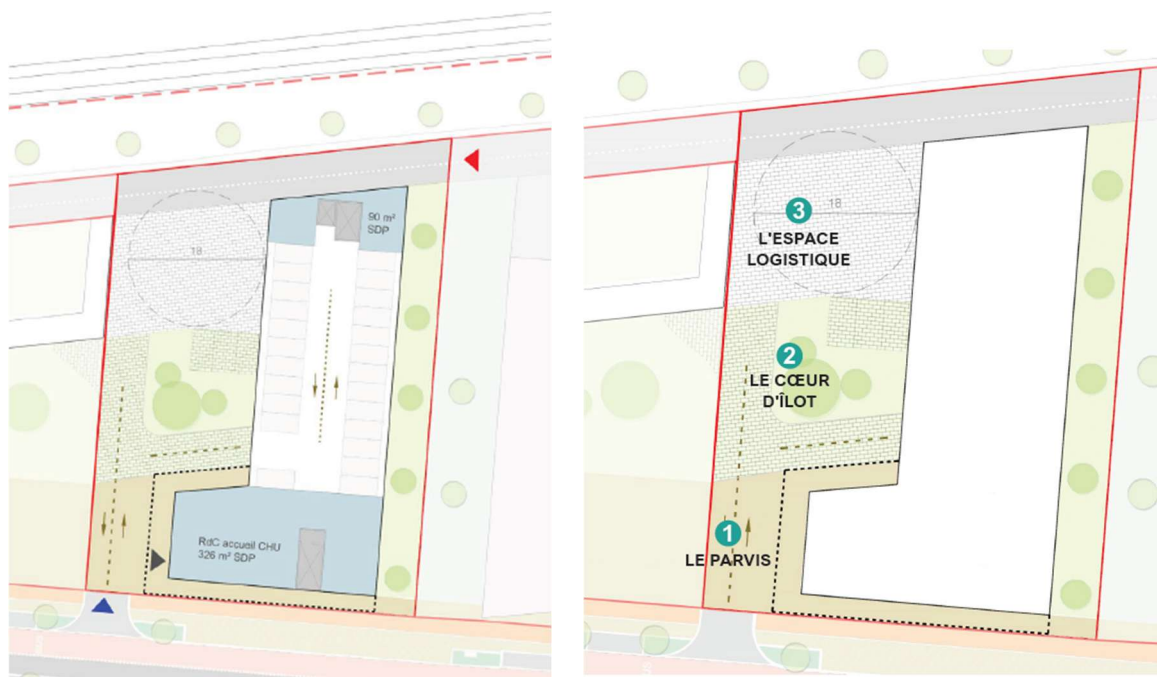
Plan du RDC et des espaces extérieurs (extrait RIS_Fiche de lot G1)
